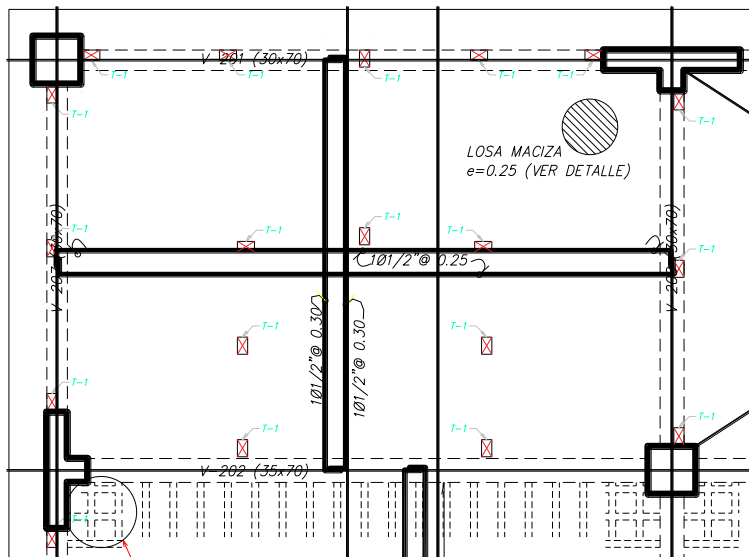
Plano de detalle de losa maciza bidireccional. (Fuente Propia).
